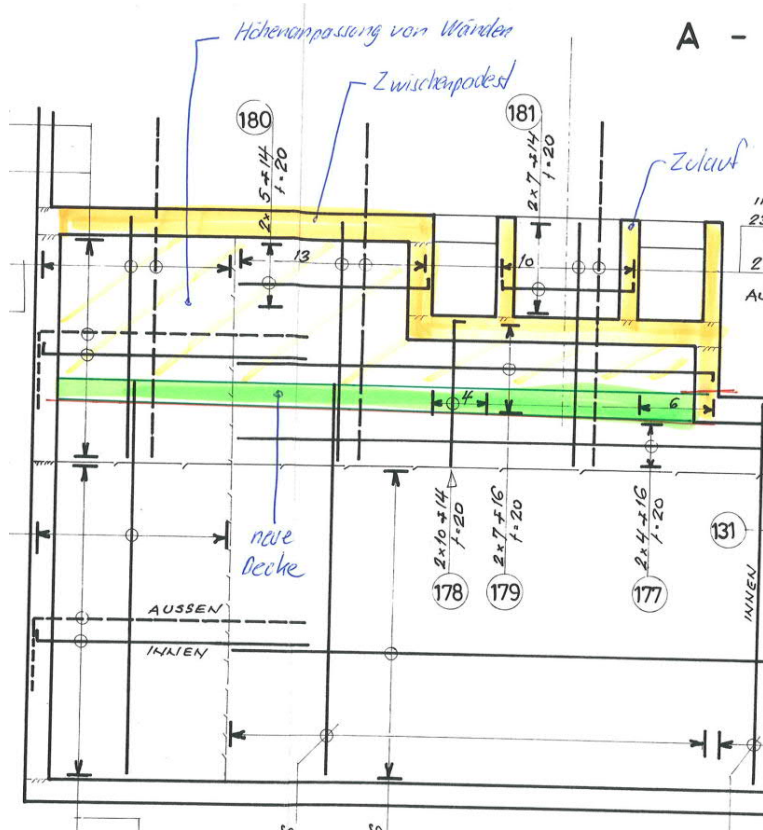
Schnitt; Schemaschnitt Rückbau im Betriebsgebäude
